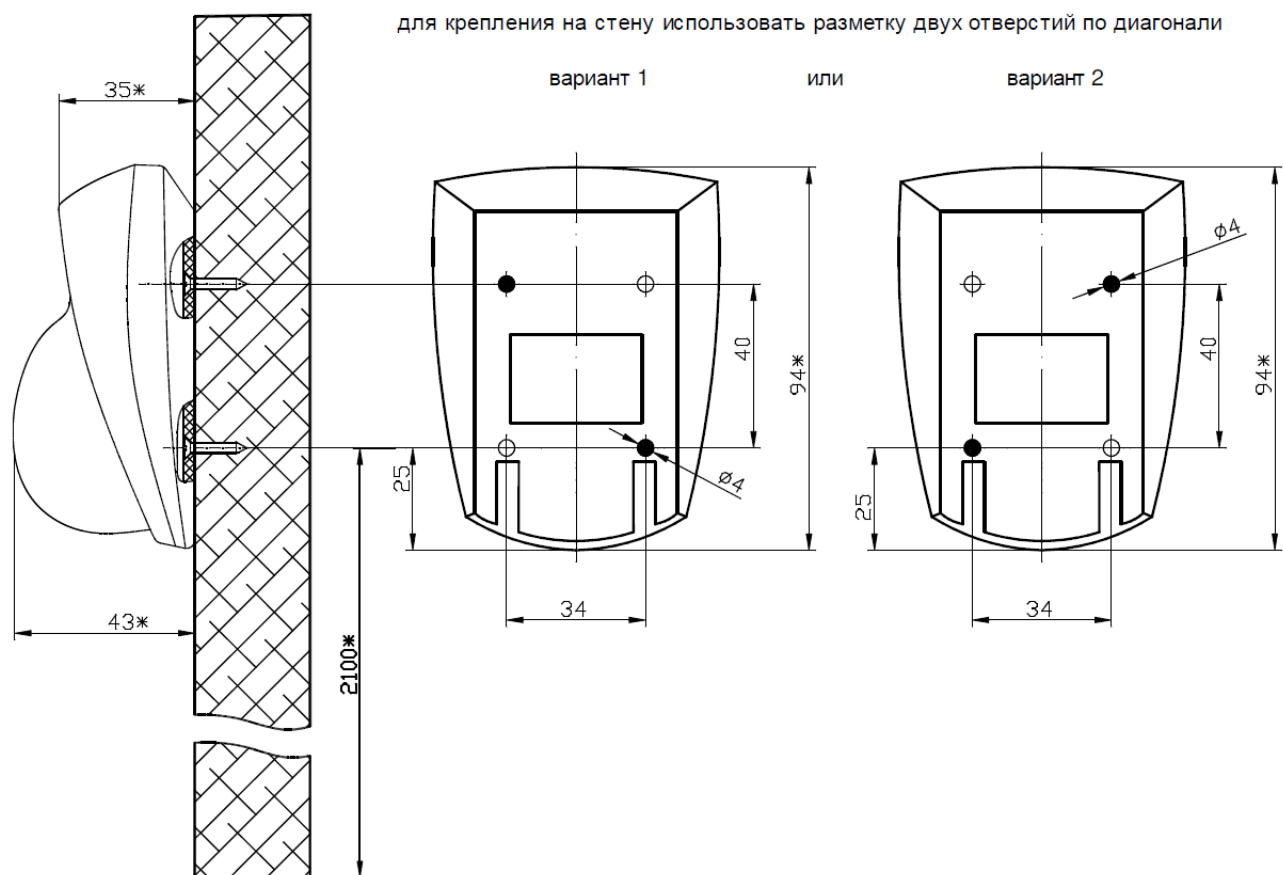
Варианты крепления извещателя на несущую поверхность
